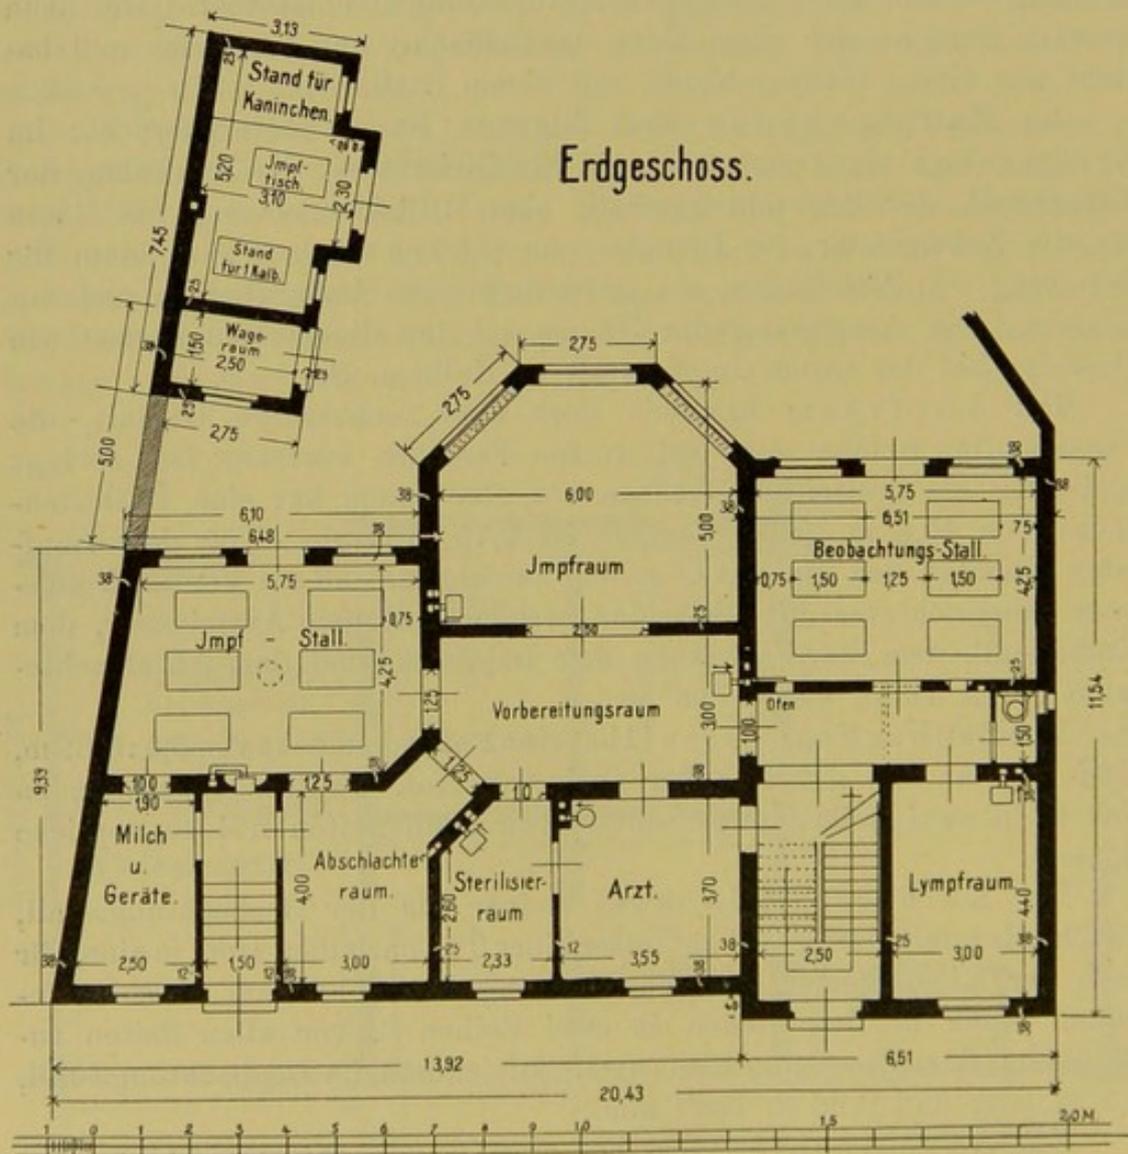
Impfanstalt in Cassel: Grundriß des Erdgeschosses.
